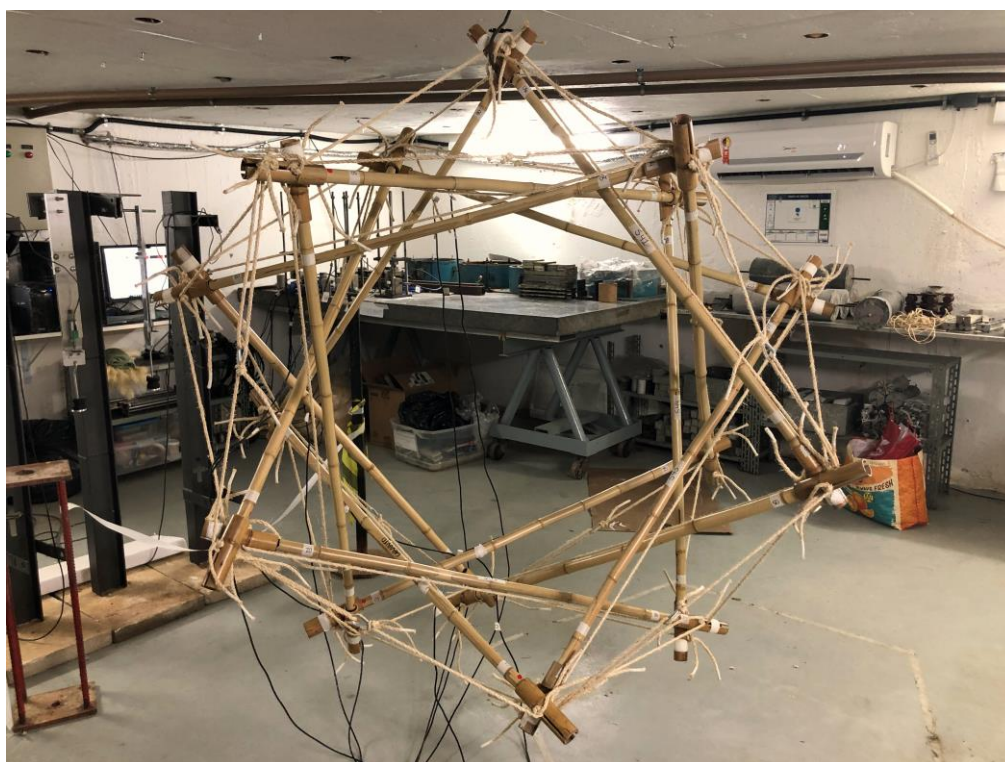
Módulo em escala 1:5,65 na posição final para ensaio
